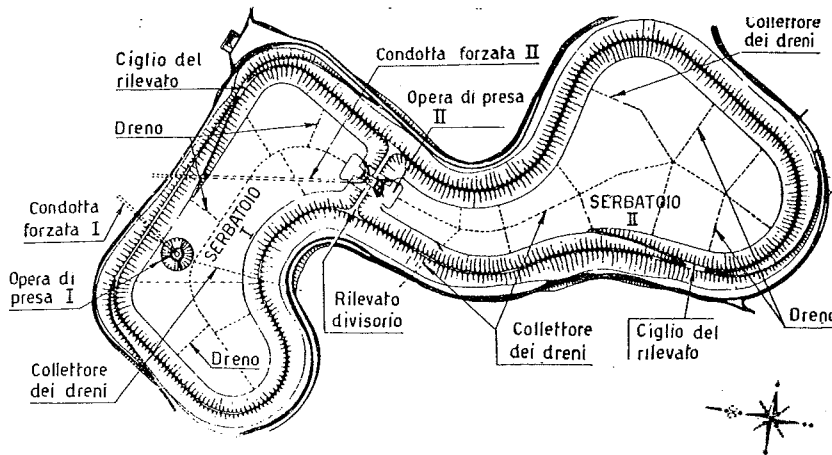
Pianta del serbatoio e delle opere annesse.
